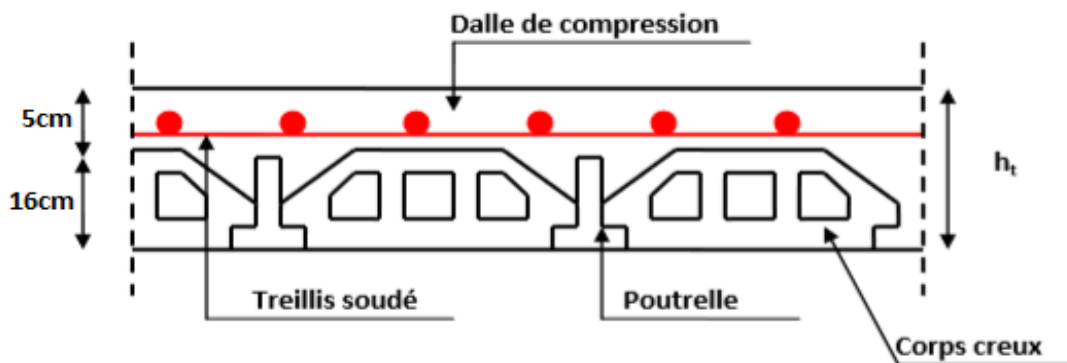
Coupe transversale d'un plancher à corps creux.
